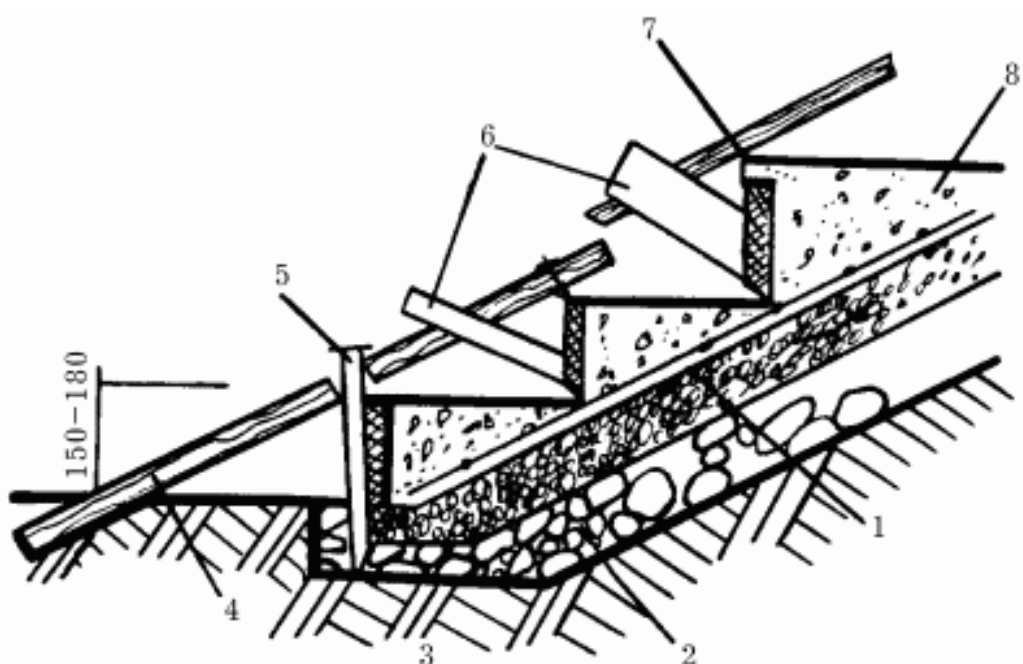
Профиль монолитной лестницы в опалубке: 1 – арматура; 2 – бутовое основание; 3 – щебень; 4 – срединная доска; 5 – кольшчек; 6 – упоры; 7 – металлический уголок; 8 – бетон.
